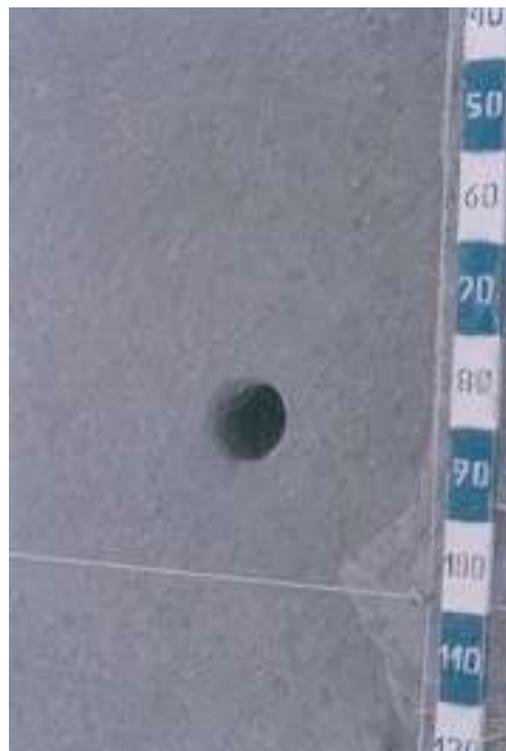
Poru Poru E. Rinconada – Excavación – Poste
